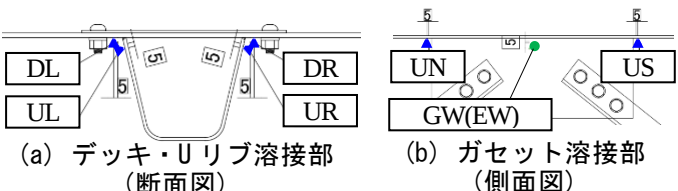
ひずみゲージ貼り付け箇所(単位: mm)
